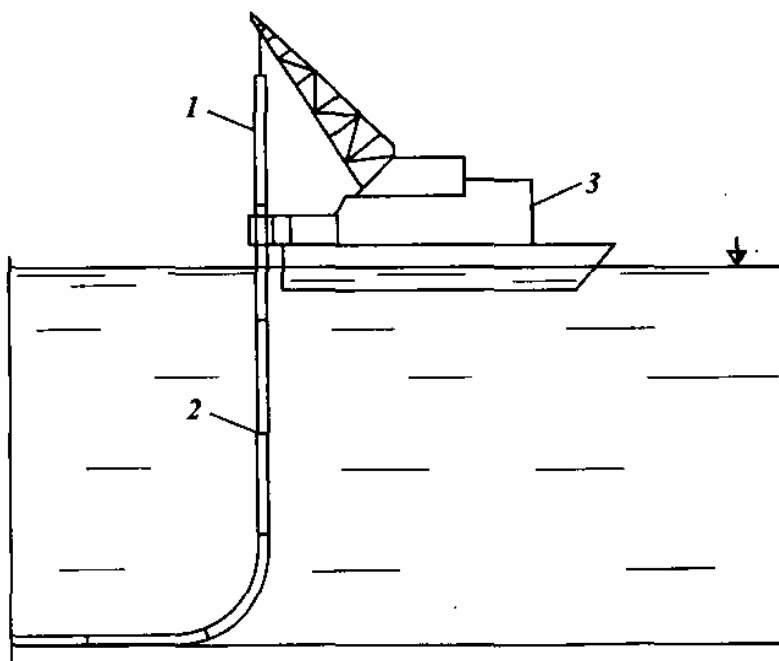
Схема укладки трубопровода на большой глубине: 1 — трубопровод; 2 — стыки соединения секций; 3 — трубоукладочное судно
